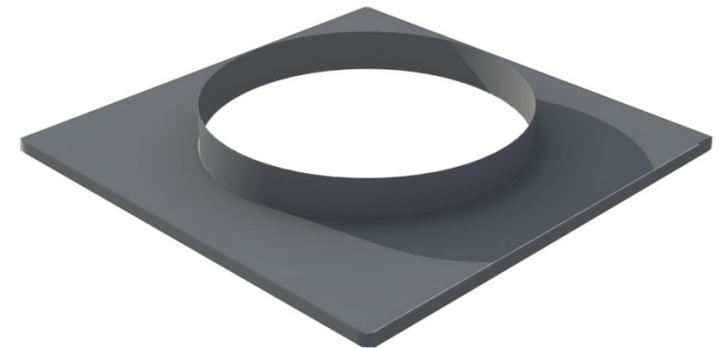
Eléments de coiffe (sans soudure) sur sortie de toit existante dans le cas de toitures-terrasses
